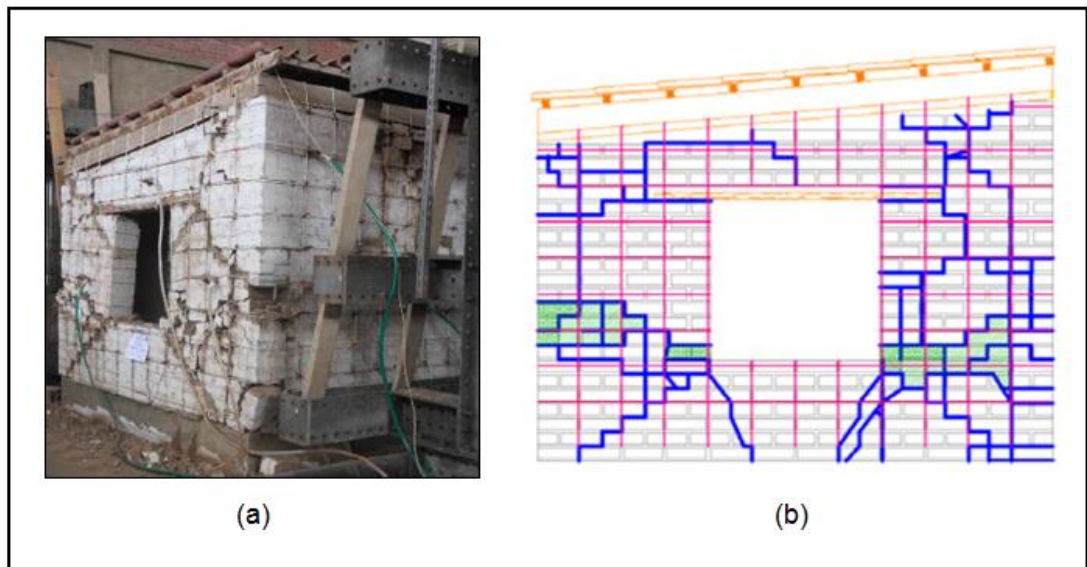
Esquema de fisuras y vista general del estado del módulo de adobe después de la última fase del ensayo. (Fuente: Sosa et al., 8, 2014)
